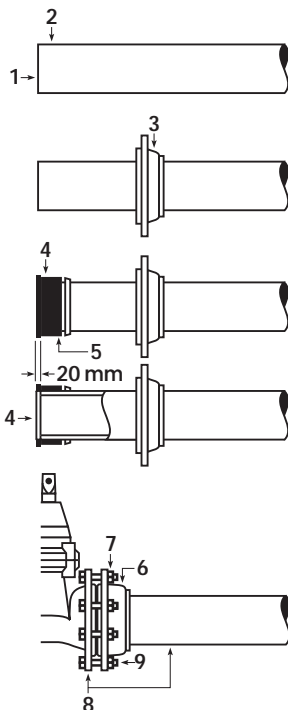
Схема присоединения устойчивого к растягивающим нагрузкам свободного фланца для ПВХ труб.
